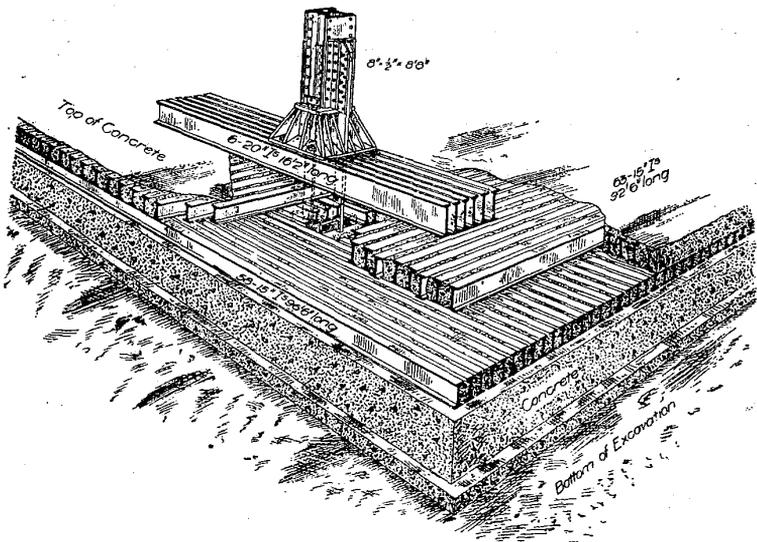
Radier général en poutrelles noyées dans un béton de ciment.
